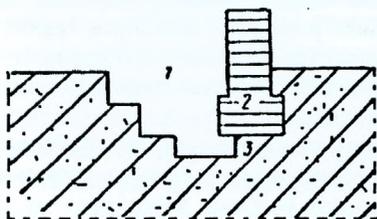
Расположение шурфа по отношению к фундаменту: 1 - шурф; 2 - фундамент; 3 - место отбора монолита.
